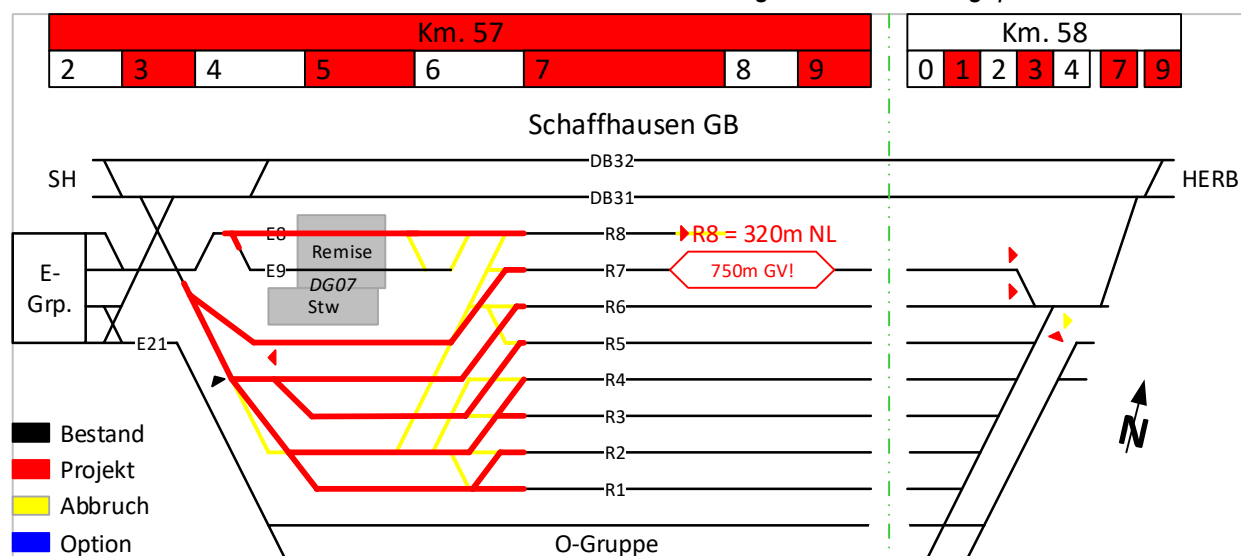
Variante 4 – Ohne Gebäudedurchfahrt GV / Abstellung durch Gebäude geplant
